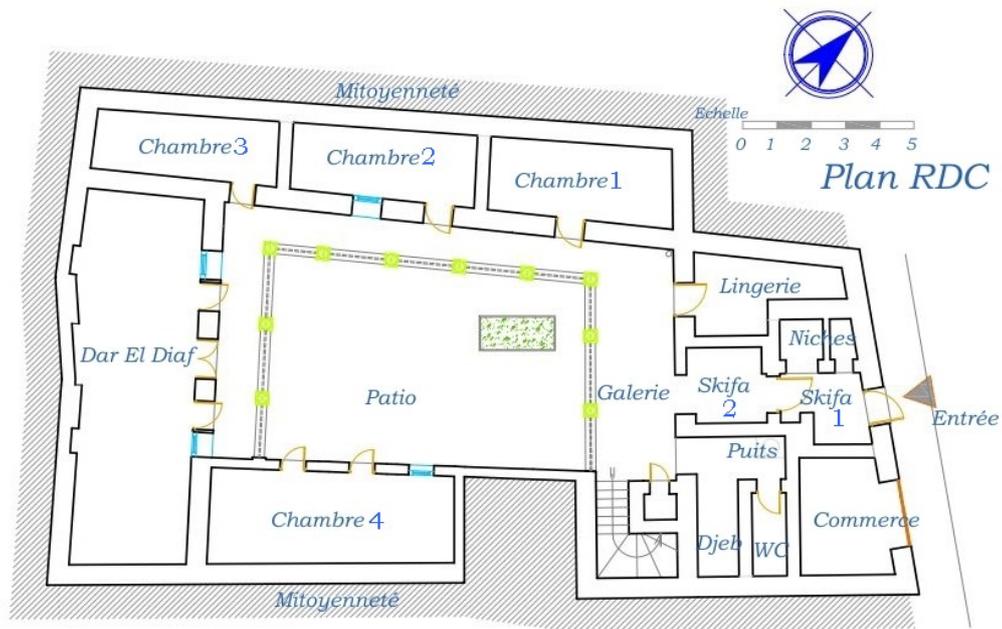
Plan du rez-de-chaussée (Source : Relevé S. Ammour, Architecte).
